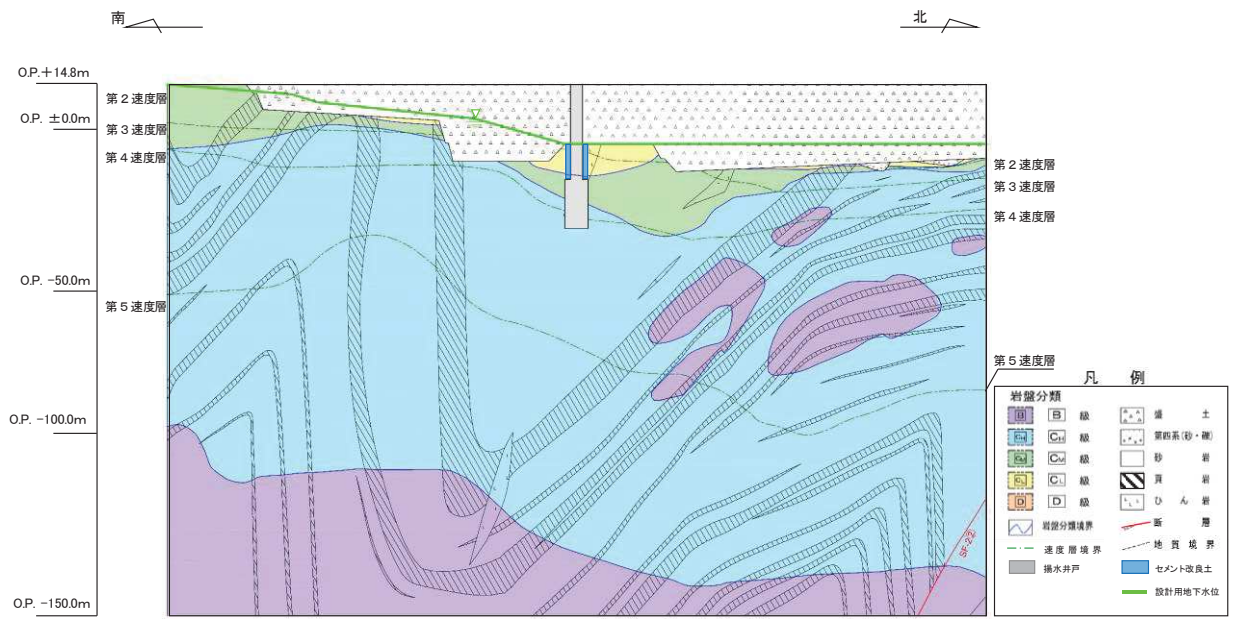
(1) No.1 揚水井戸 評価対象断面図 (A' -A断面)
